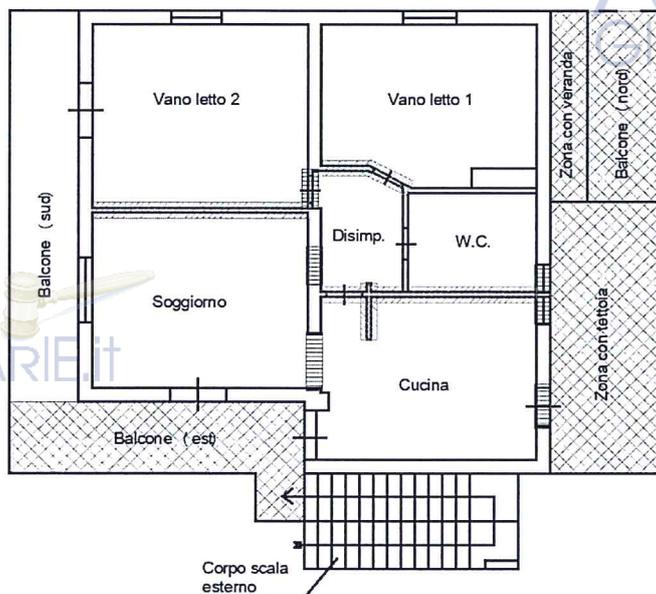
Pianta piano primo – difformità rispetto planimetria di progetto (sanatoria 1986)
